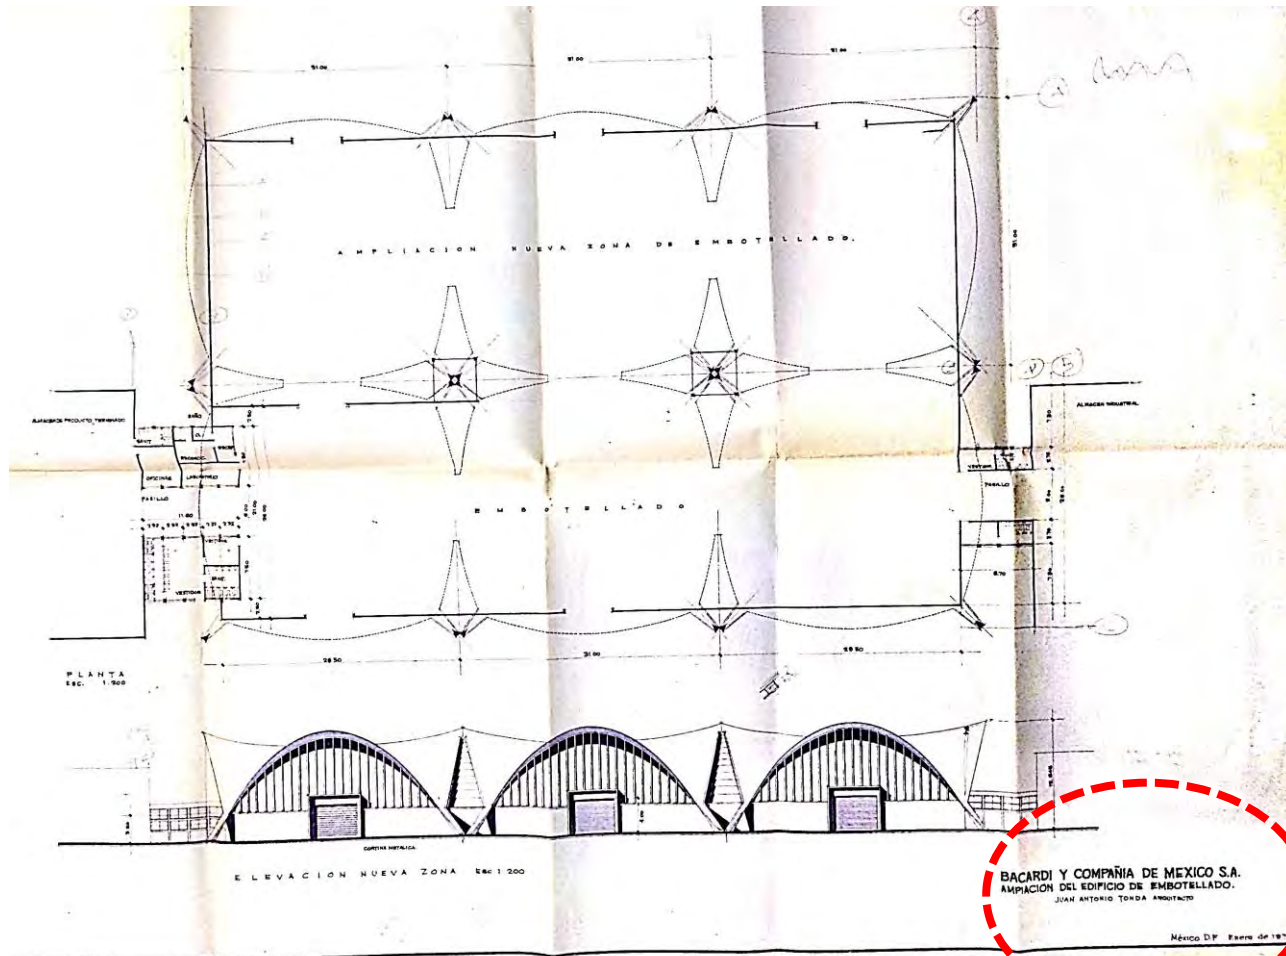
Proyecto Ampliación Planta Embotelladora Bacardí ,
